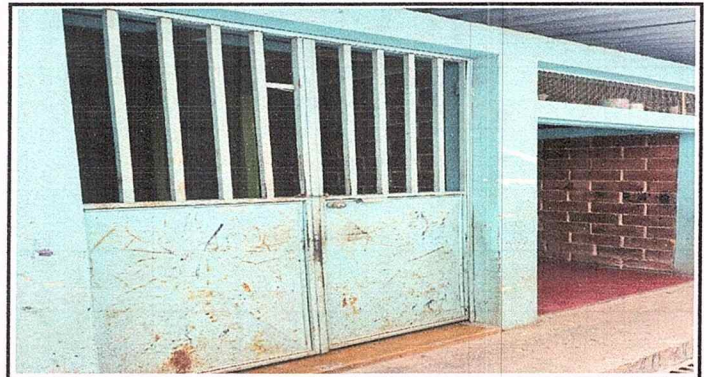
MODULO 2 MANTENIMIENTO A ESTRUCTURA DE PUERTA LIJADO, CEPILLADO, APLICACIÓN DE PINTURA
